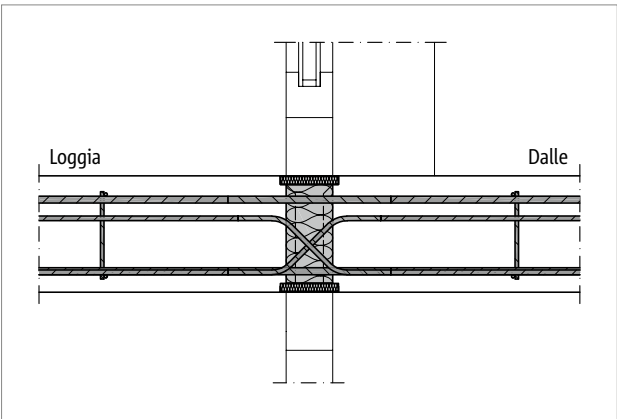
Schöck Rutherma® T type D : coupe de principe ; dalle portée sur deux appuis
